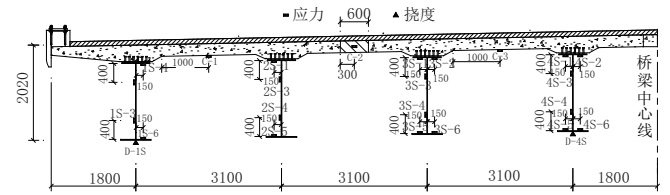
钢板组合梁监测断面测点布置示意图(单位:mm)
